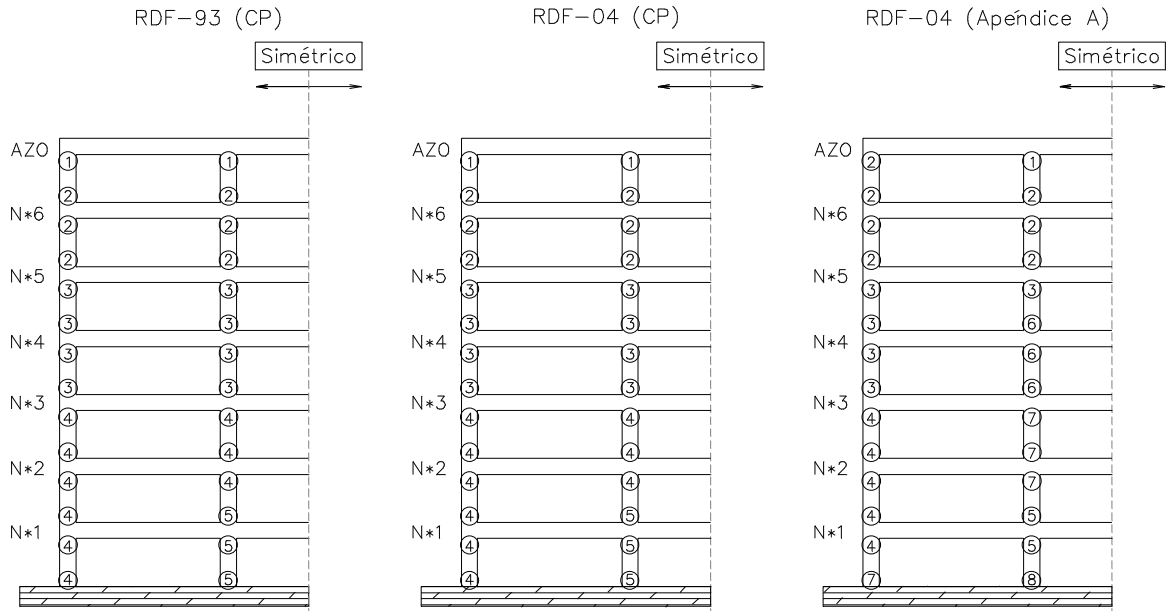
Ubicación de los tipos de armados de columnas del eje 2, estructuras de 7 niveles, diseños en zona II (RDF-93 y RDF-04)
